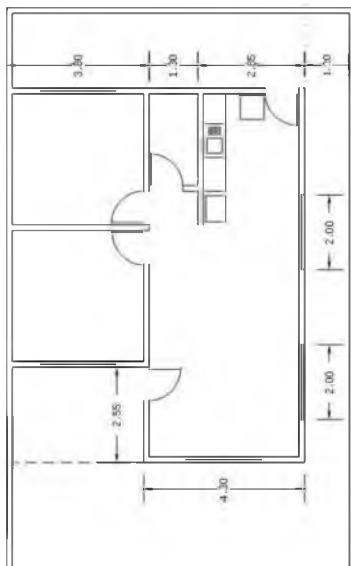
Detalle de Bocetos Digital en una planta Arquitectónica. Diseñadas por autor.
